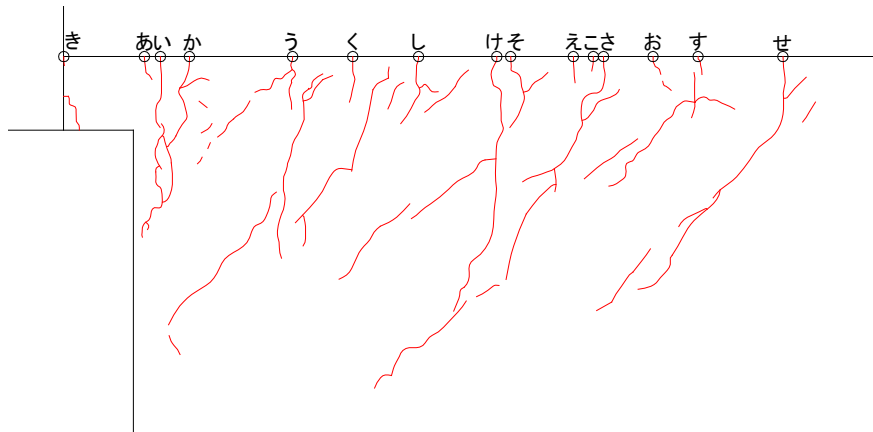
基礎梁ひび割れ幅測定位置(試験体 A-6 負荷荷)
